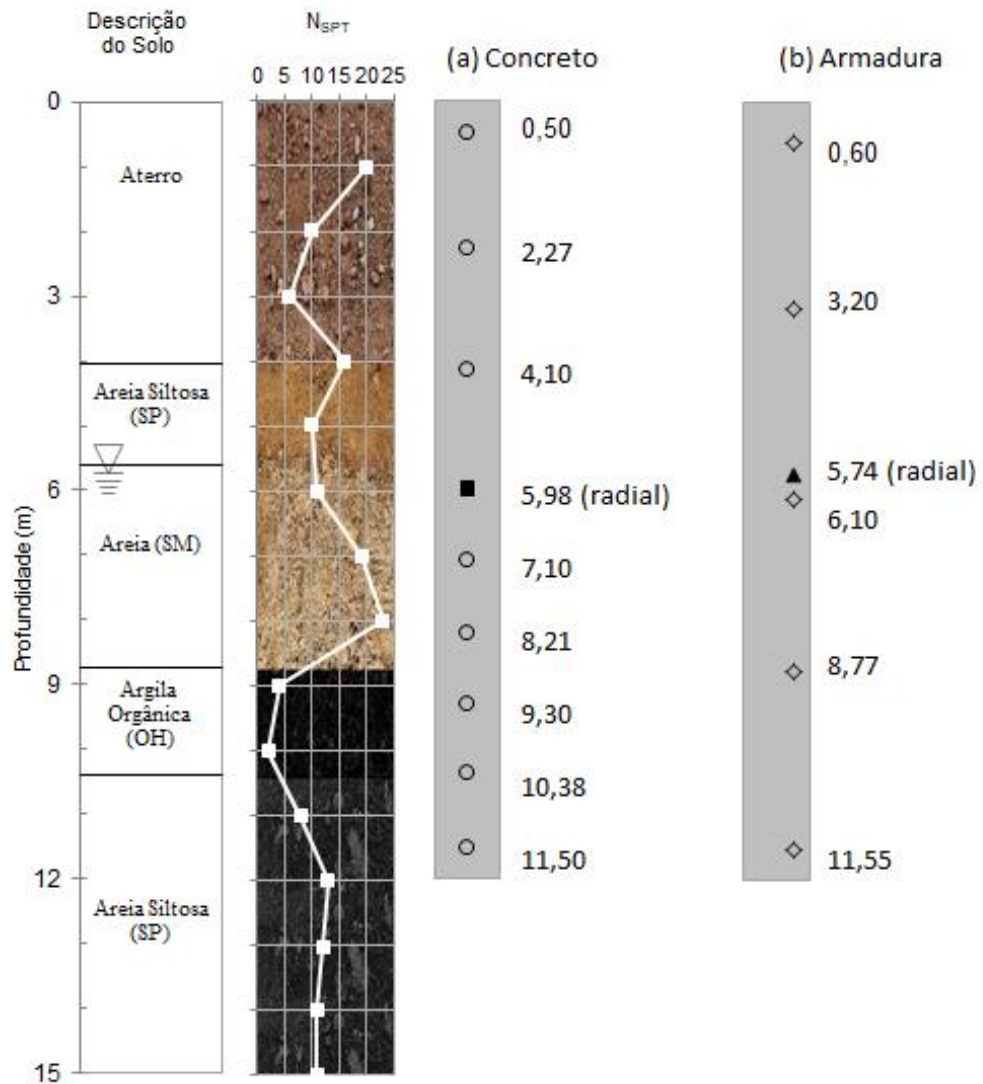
Disposição dos extensômetros e termopares no interior da estaca geotérmica: (a) concreto; (b) armadura.
